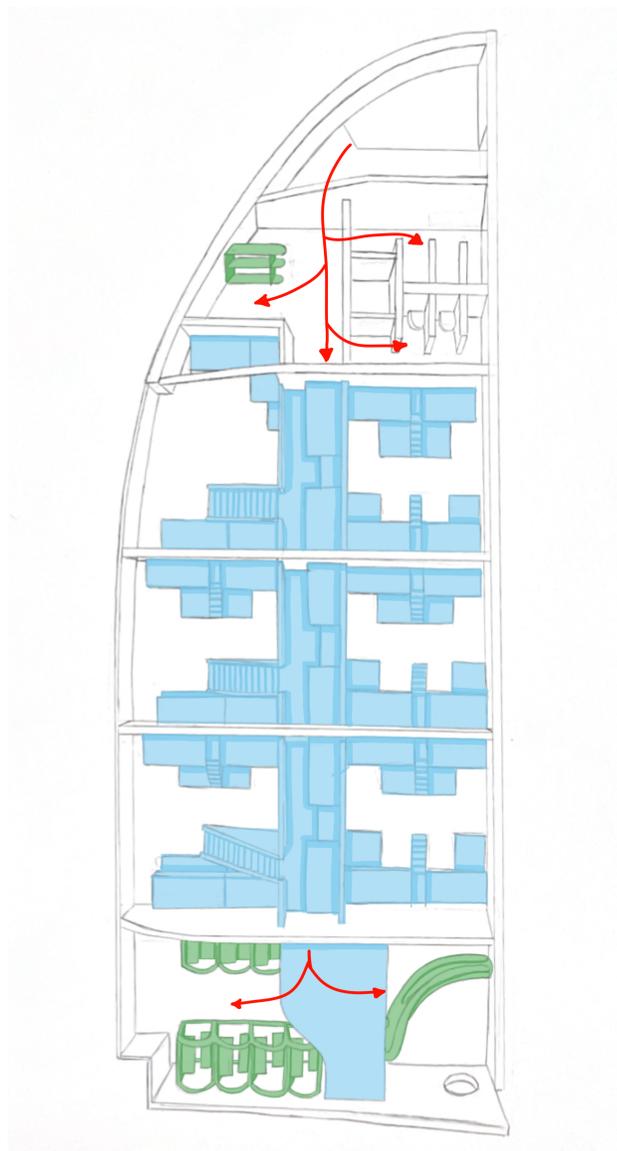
Boceto final en planta de la distribución de los bloques. [3]
